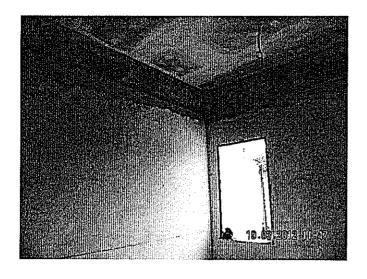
Stanza 1.4- Vista interna.angolo finestra
